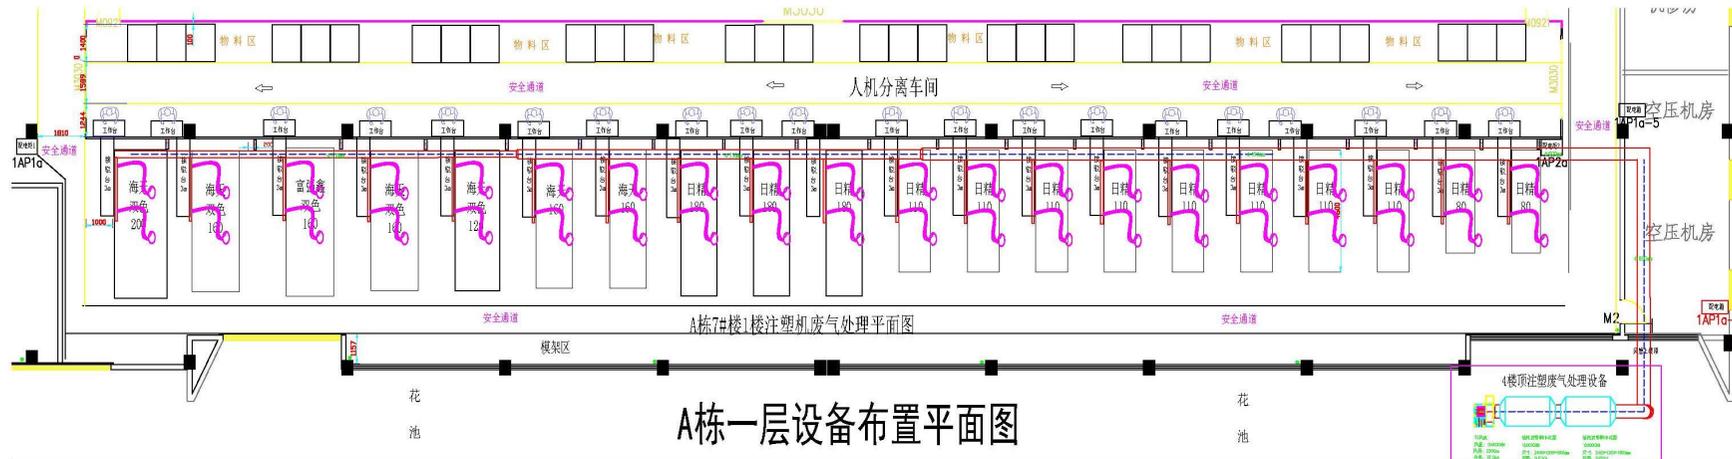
项目一楼注塑车间平面布置图（一期 20 台注塑机）
